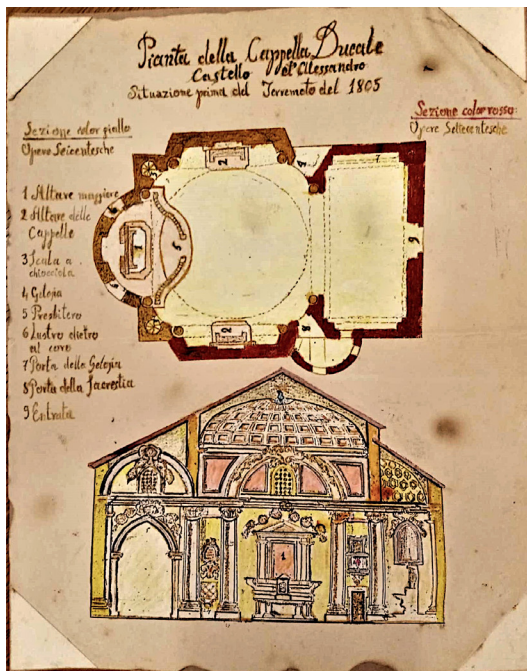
Archivio Centro Studi d'Alessandro, tomo X, *Mappa planimetrica cappella esterna in ristrutturazione*, 1788-1789 ca. Foto: Archivio di Ettore d'Alessandro di Pescolanciano.
